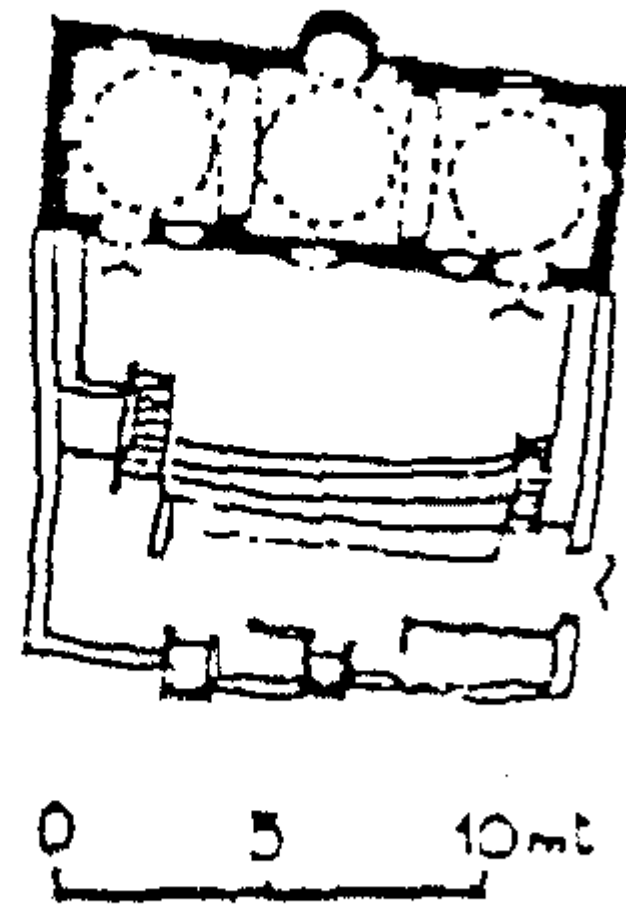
زبيد ، مسجد الصنوى ، المسقط الأفقى
